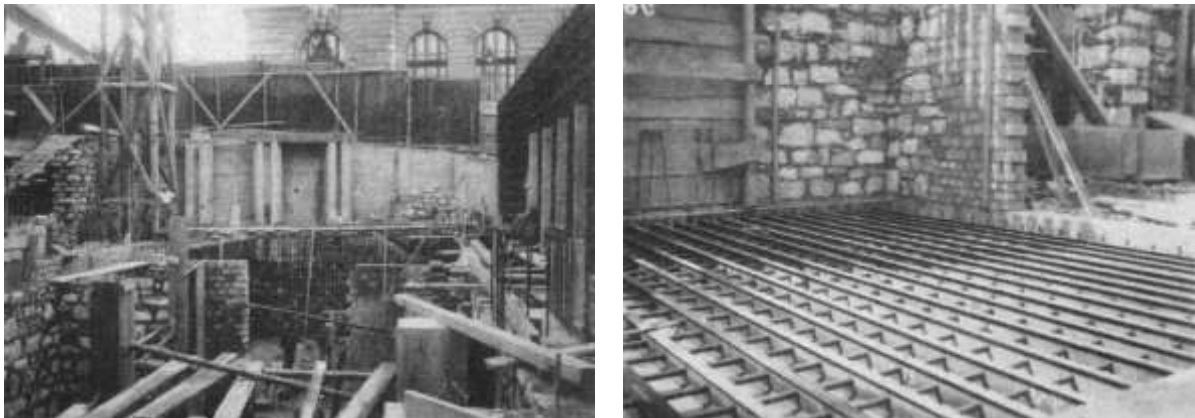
Construction des fondations et des planchers (Reportage photographique du chantier de construction, 1921, Archives UBS).
